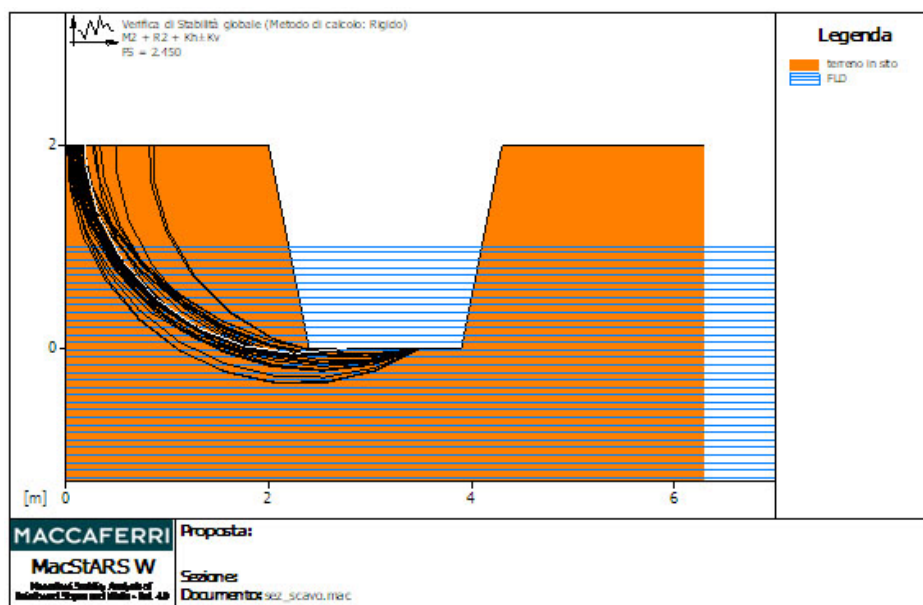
esito della verifica, in condizioni dinamiche, dalla stabilità della sezione tipo di scavo
